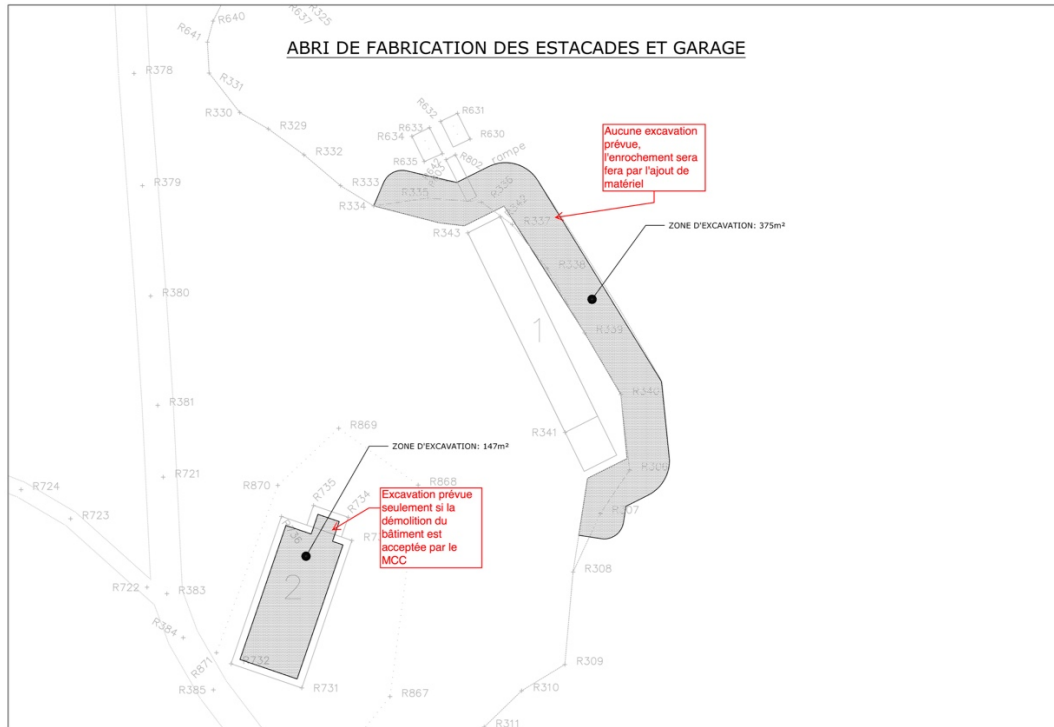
Travaux d'excavations prévus autour du hangar à estacades et du garage
